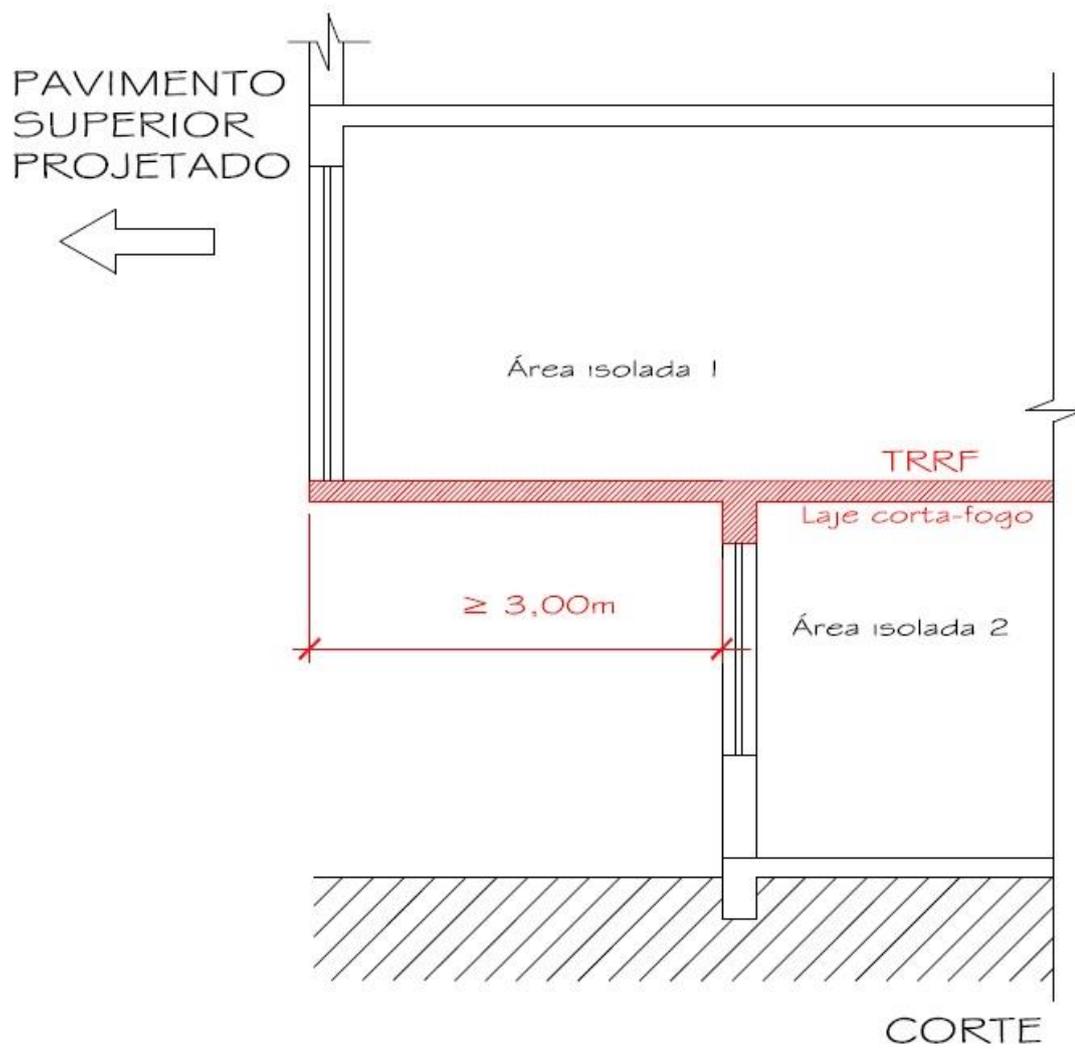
Projeção mínima de 3,00 m entre pavimentos isolados
